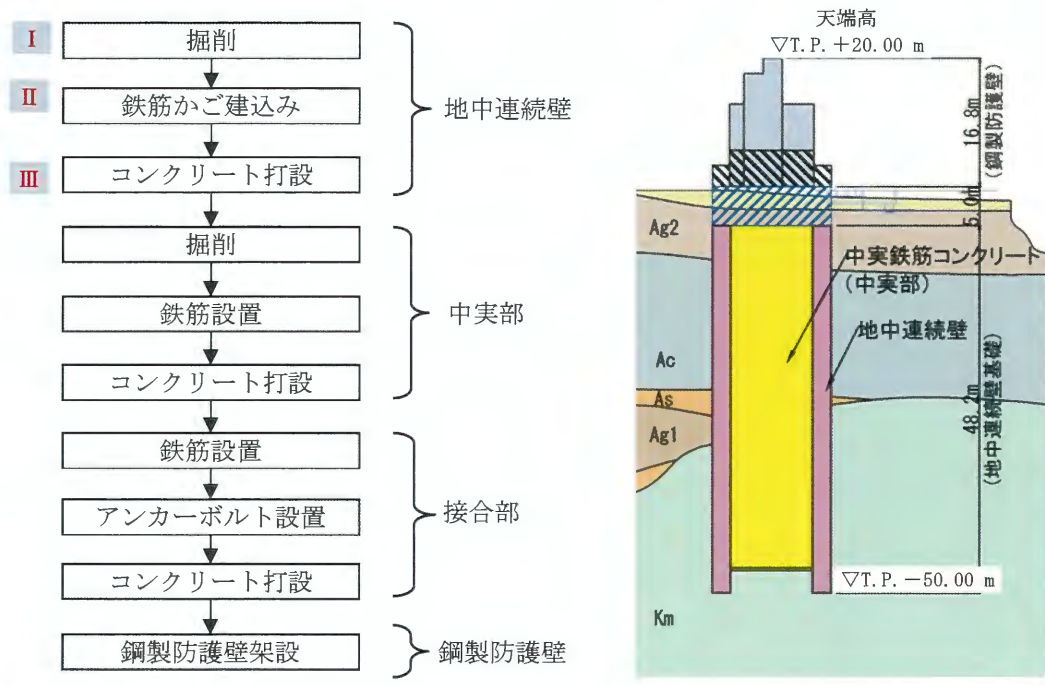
防潮堤（鋼製防護壁）の施工手順
